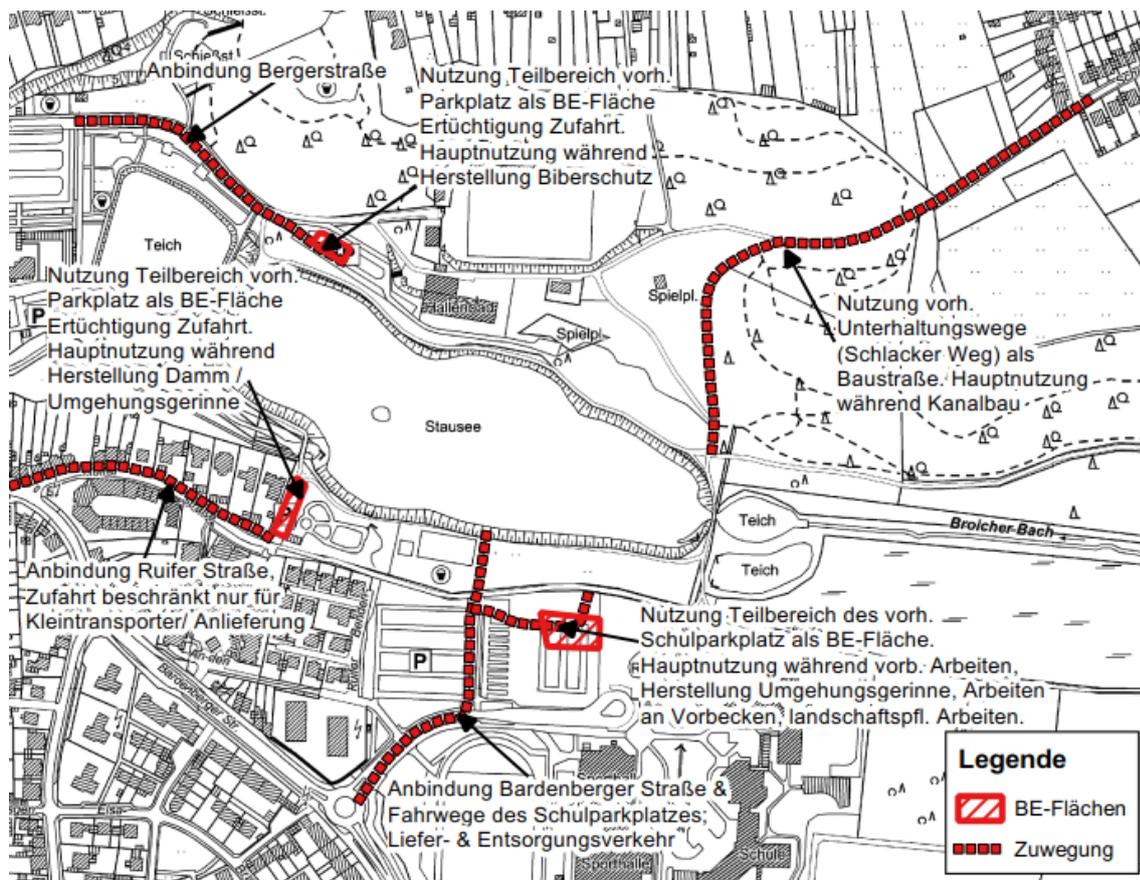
Baustellenerschließung und BE-Flächen (Ausschnitt GEW-ÜLP-G-103)
